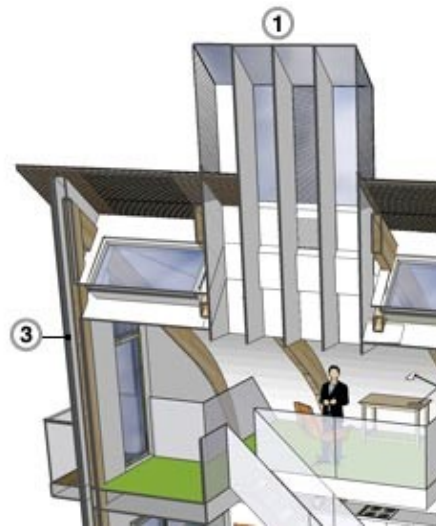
英國光屋(Kingspan Light House)整體空間規劃^[D2]
